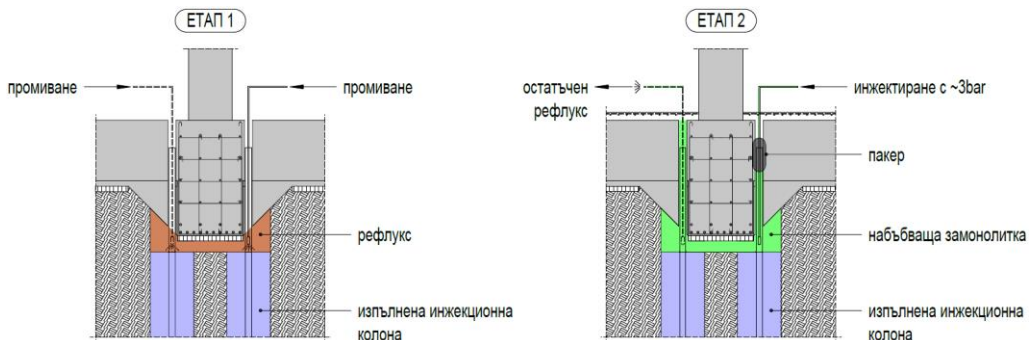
Изпълнение на комплексен метод за подобряване на параметрите на земната основа и усилване на фундаментната конструкция чрез прилагане на технология „jet-grouting“
